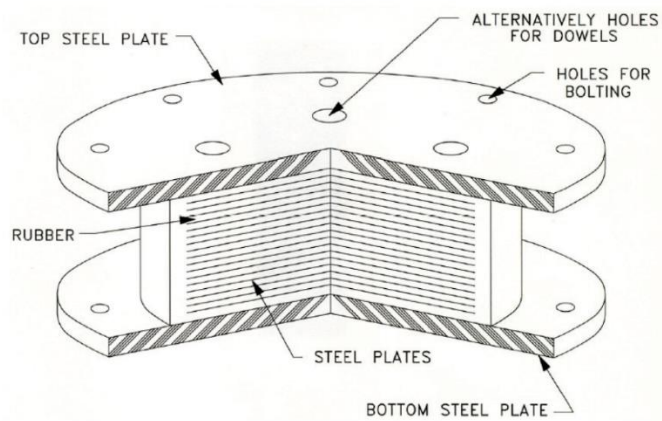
Aislador convencional (Constantinou et. al, 2007).
